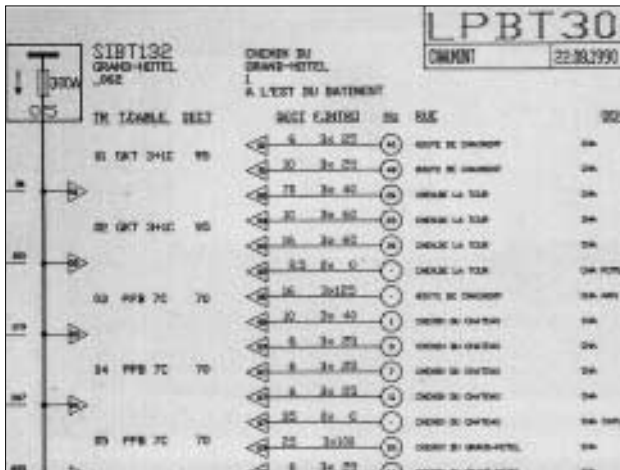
Exemple d'un plan schématique d'un réseau.
